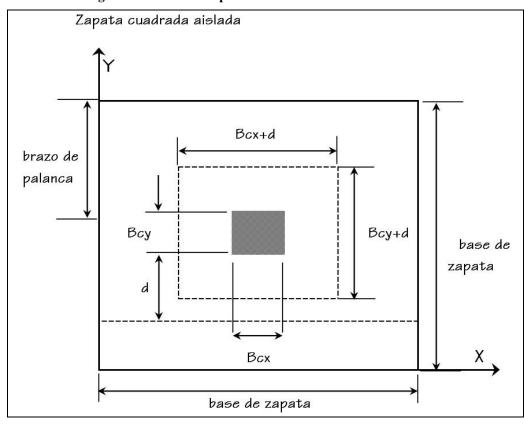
Detalles de zapata aislada cuadrada sin excentricidad
